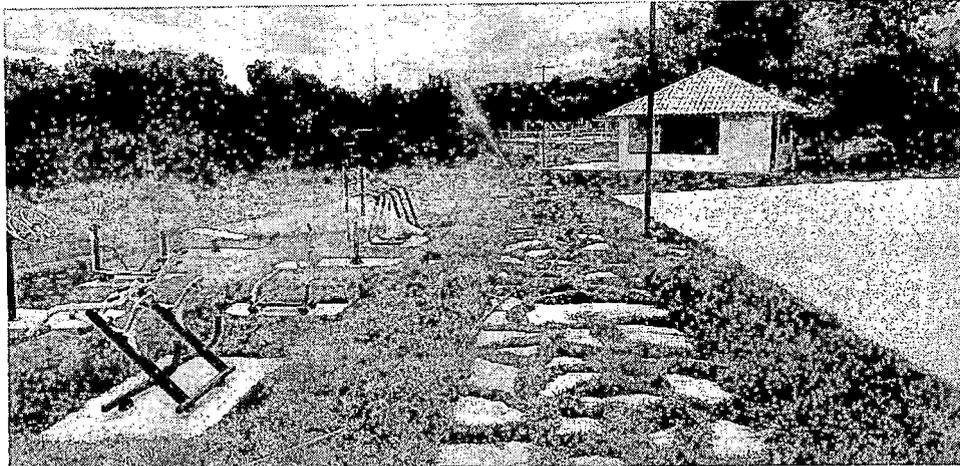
LUMINÁRIAS EXTERNAS DO TIPO POSTE INSTALADAS NA ÁREA COMUM.
